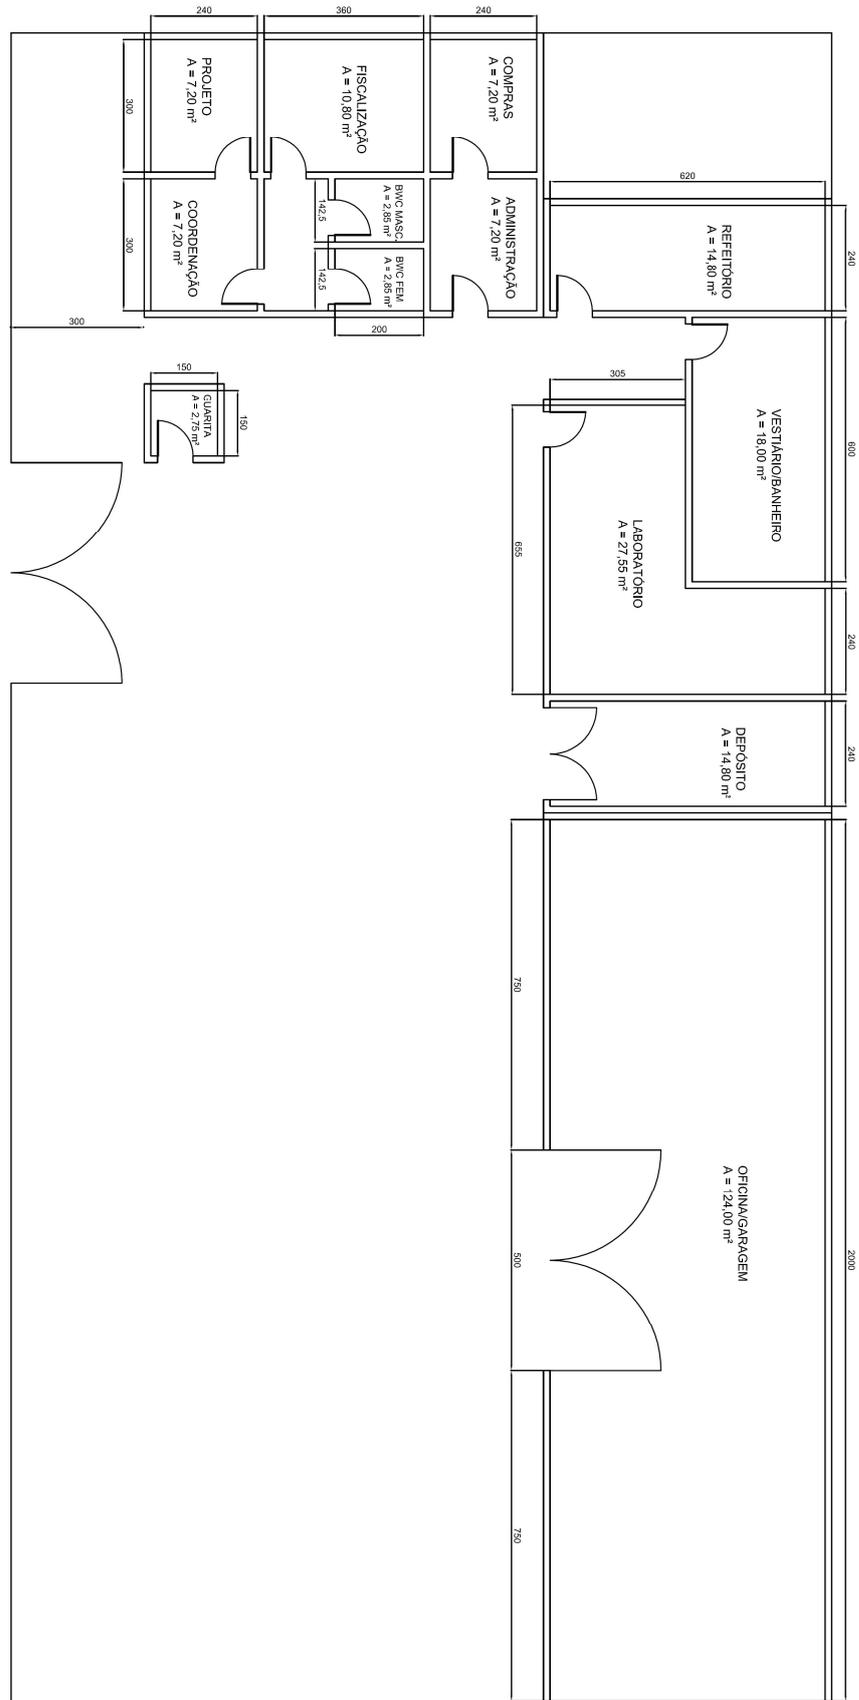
LAY-OUT PROPOSTO PARA O CANTEIRO DE OBRAS
